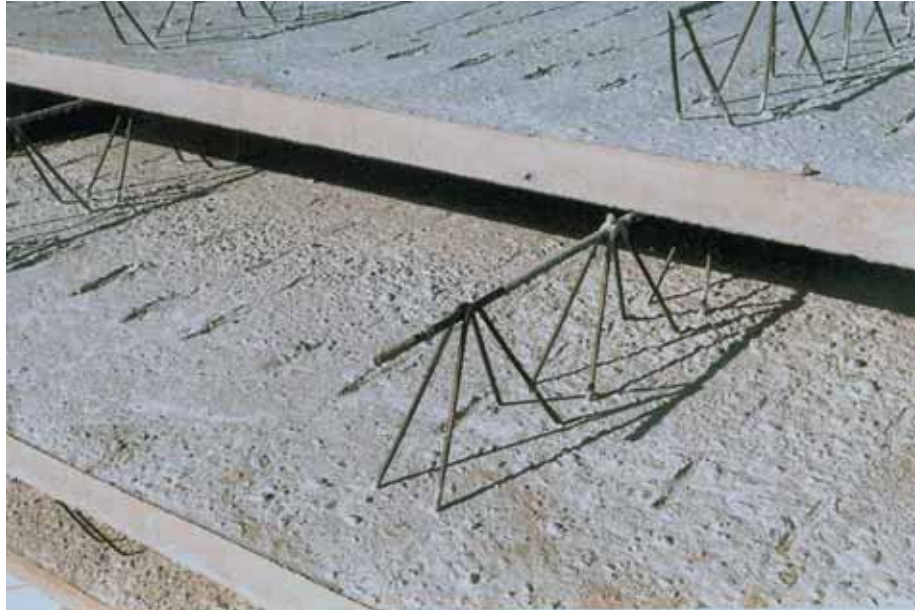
Een detailopname van een bekistingplaat met een ruwgemaakt bovenzvlak en de driehoekige tralieligger. De plaat ligt op de bovenstaaf van de tralieligger
